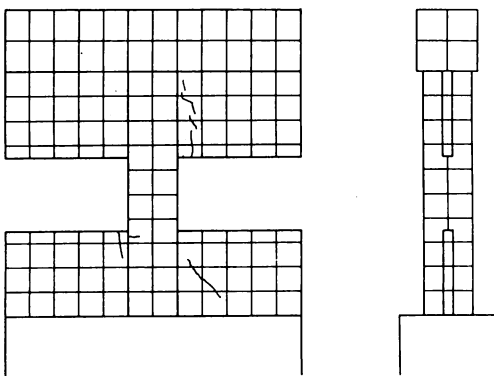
(d) 試験体 CSS04 の初ひび割れ図
